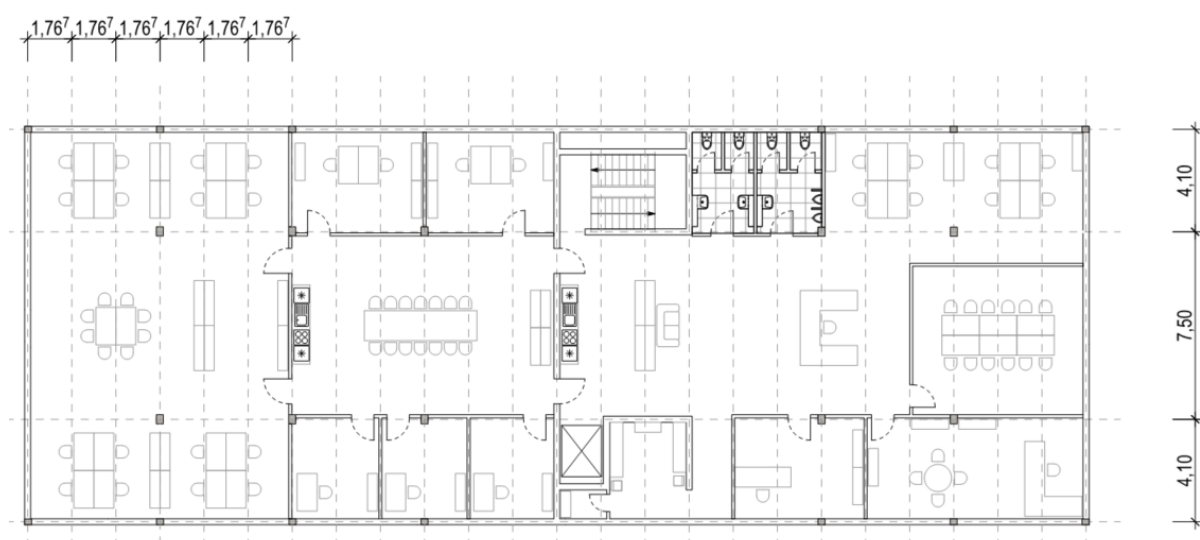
Grundrissvariante Büronutzung für Konzept 2
